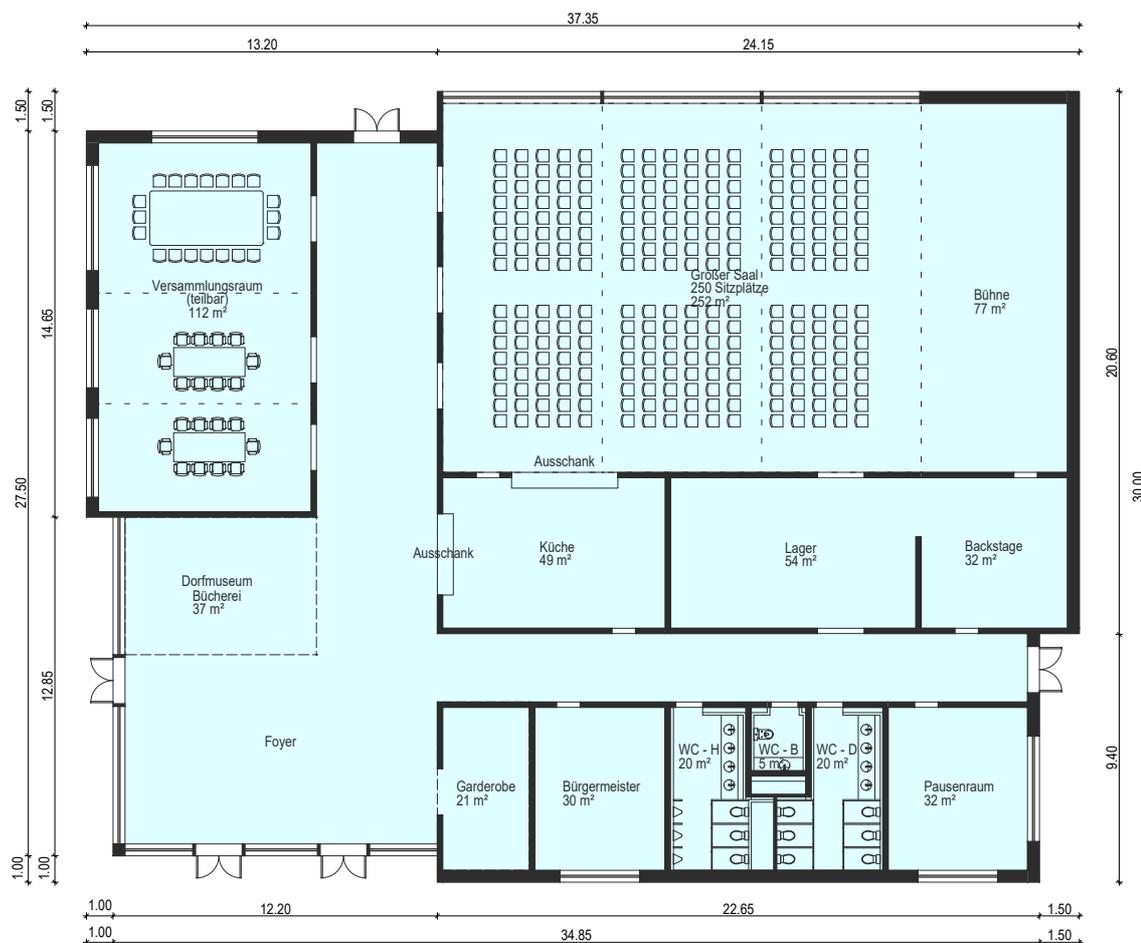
Grundriss Dorfgemeinschaftshaus Neubau (ohne Maßstab)
